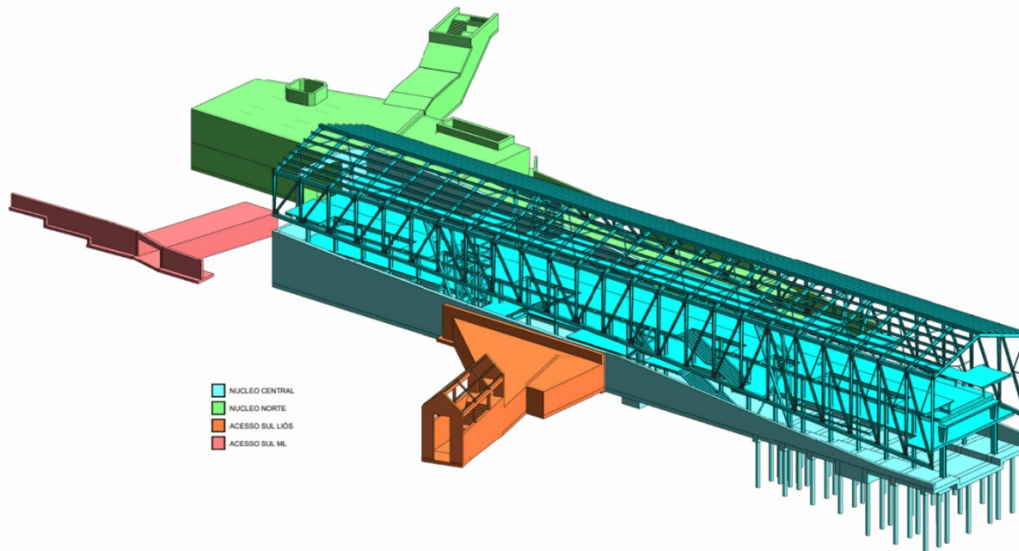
Vista 3D do modelo REVIT da estrutura da estação
